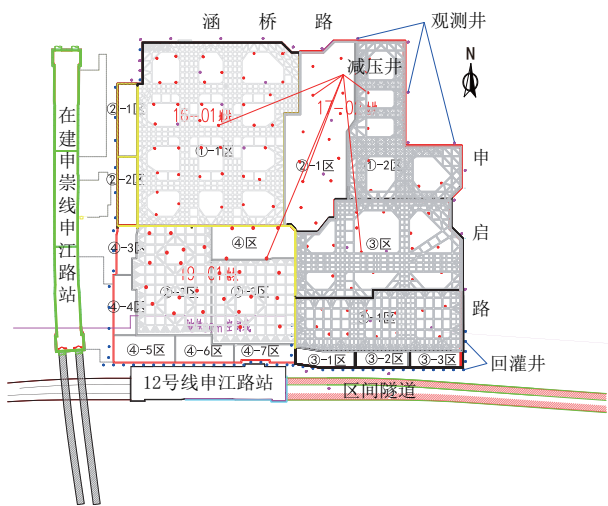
基坑内减压井及其备用井、基坑外观测井及回灌井平面布置图
